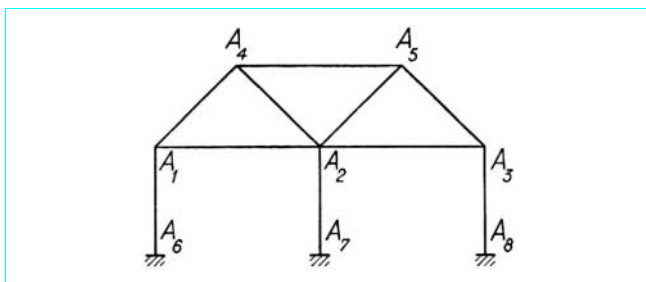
Structure élastique composée de poutres assemblées rigidement entre elles
